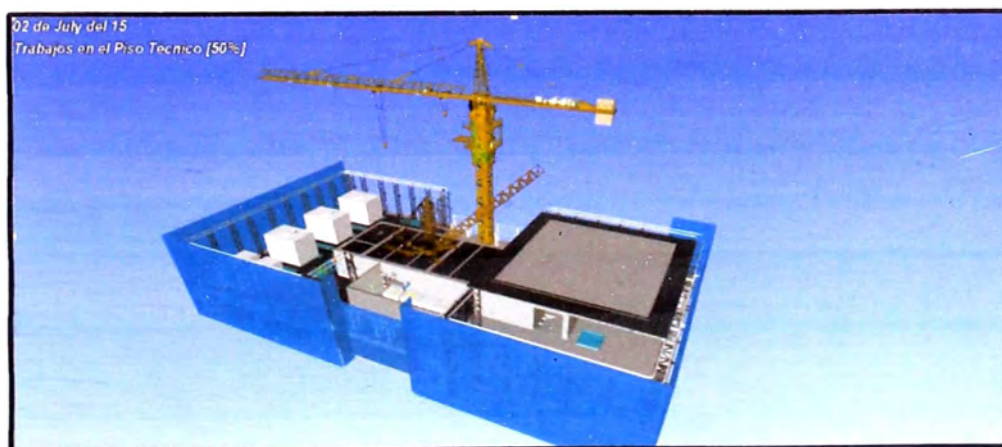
42: 4D de la Coronación del Edificio, Montaje del Derrik para desmontaje de la TC1, colocación de muro cortina y equipos
